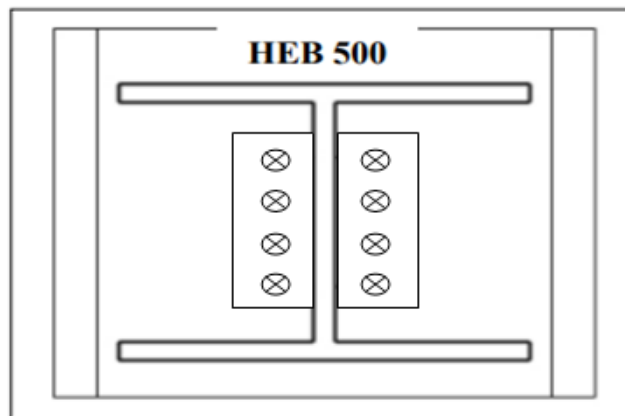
Assemblage de poteau-poutre secondaire par double cornière.
